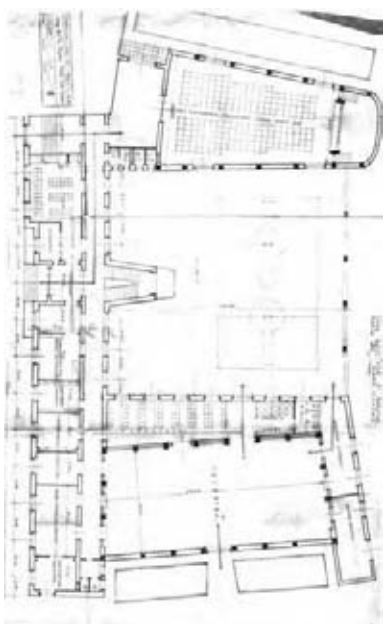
Casa del Balilla, pianta del pianoterra, prima versione
